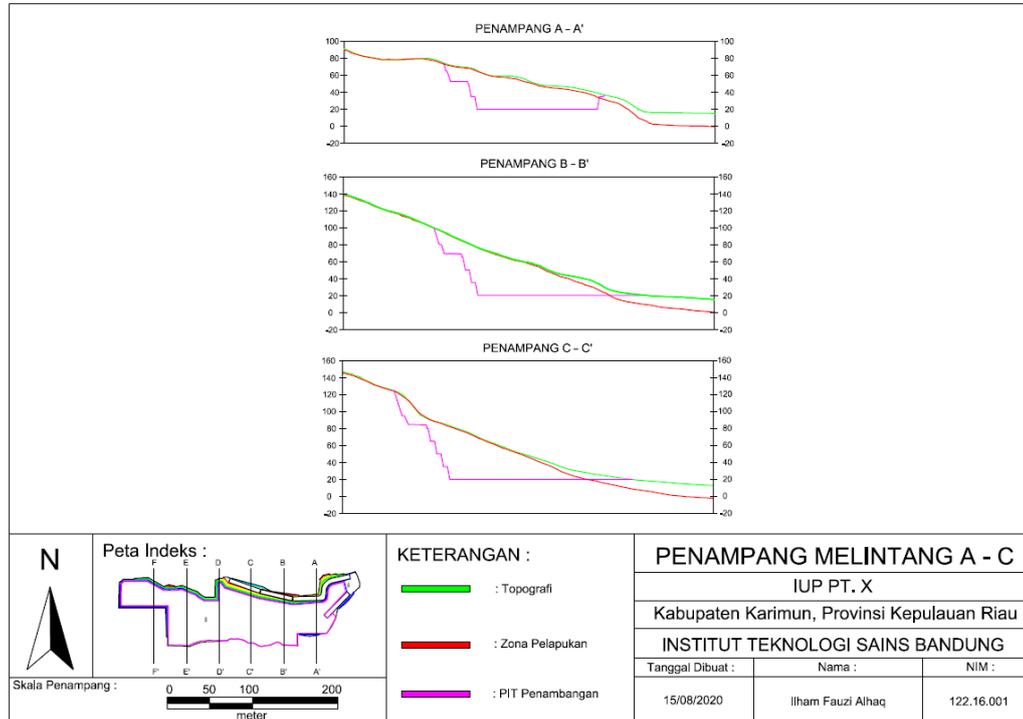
Rancangan Desain PIT Tahun ke-5
